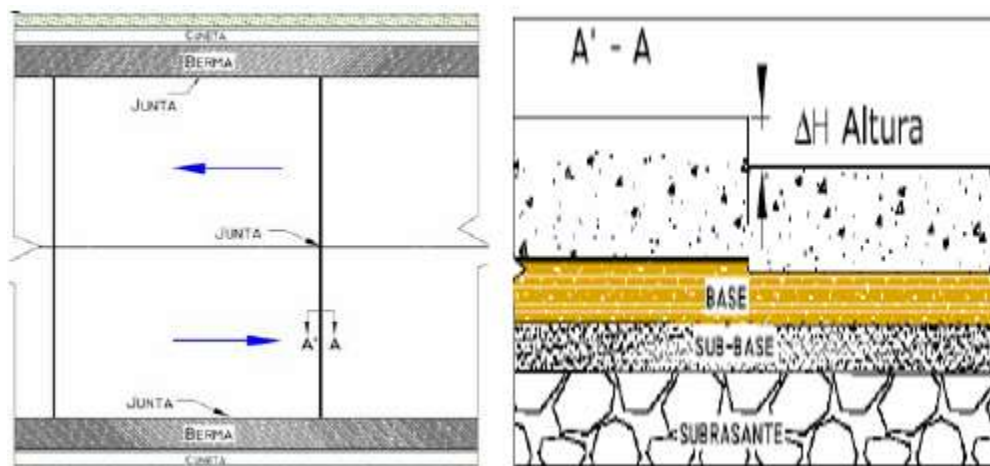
Vista de planta y perfil de escalonamiento (EJL-EJT) (INVIAS, 2006).
